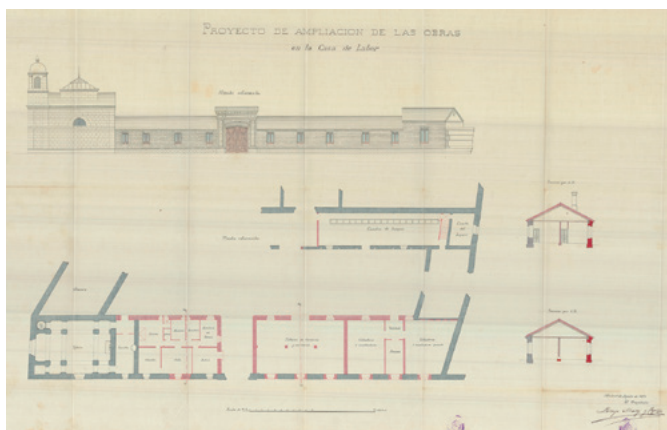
Proyecto de ampliación de las obras de la Casa de Labor. Lorenzo Álvarez y Capra, 1879. Fuente: AGA, Fondo Ministerio de Educación, IDD (05)001.025, Caja 31/08132.
